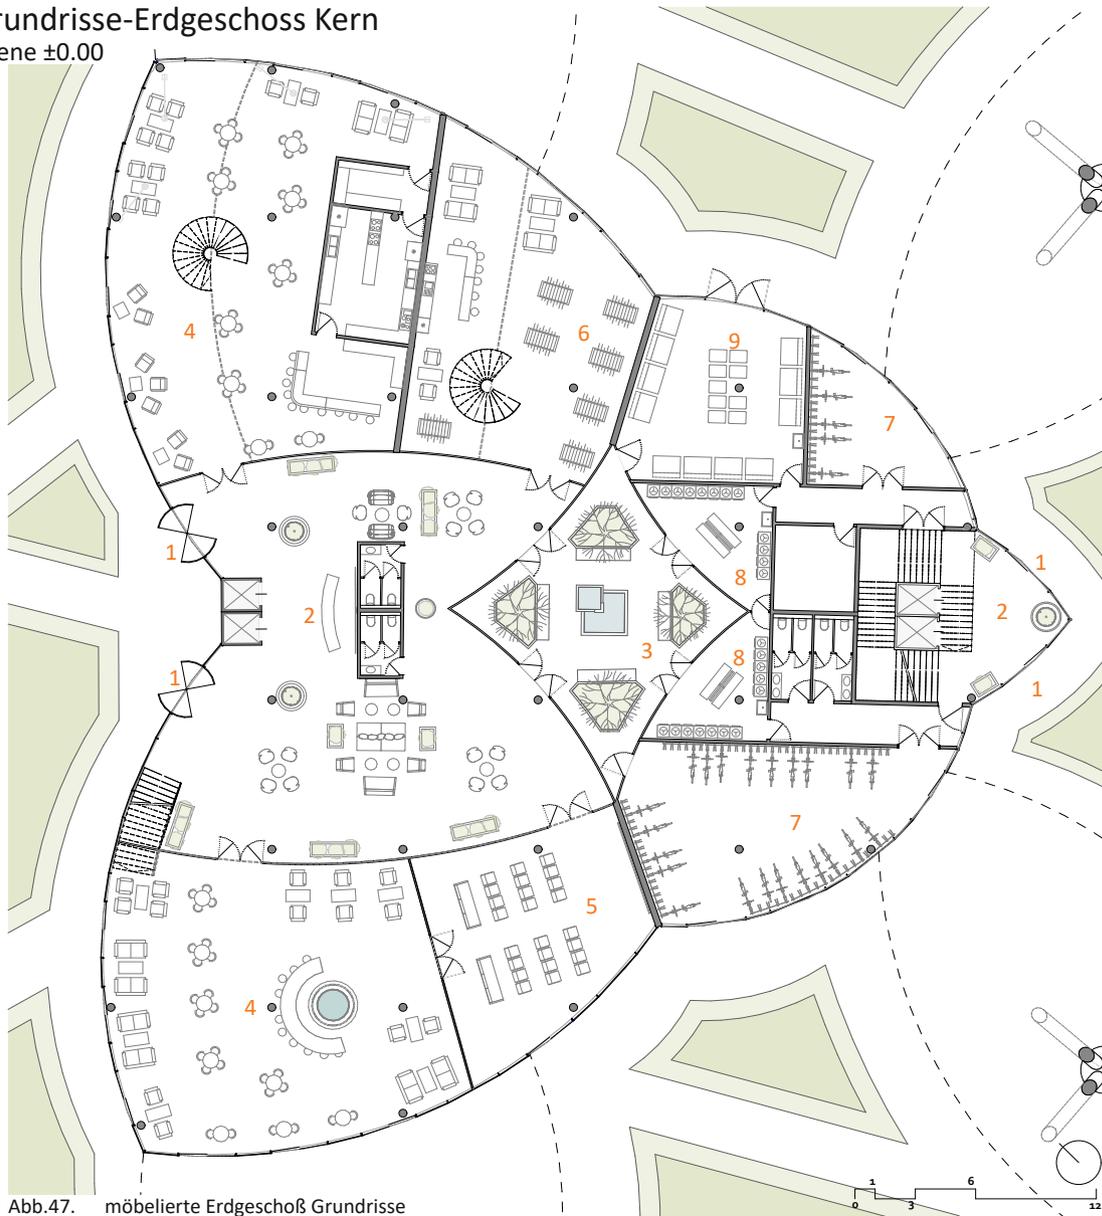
möblierte Erdgeschoß Grundrisse
